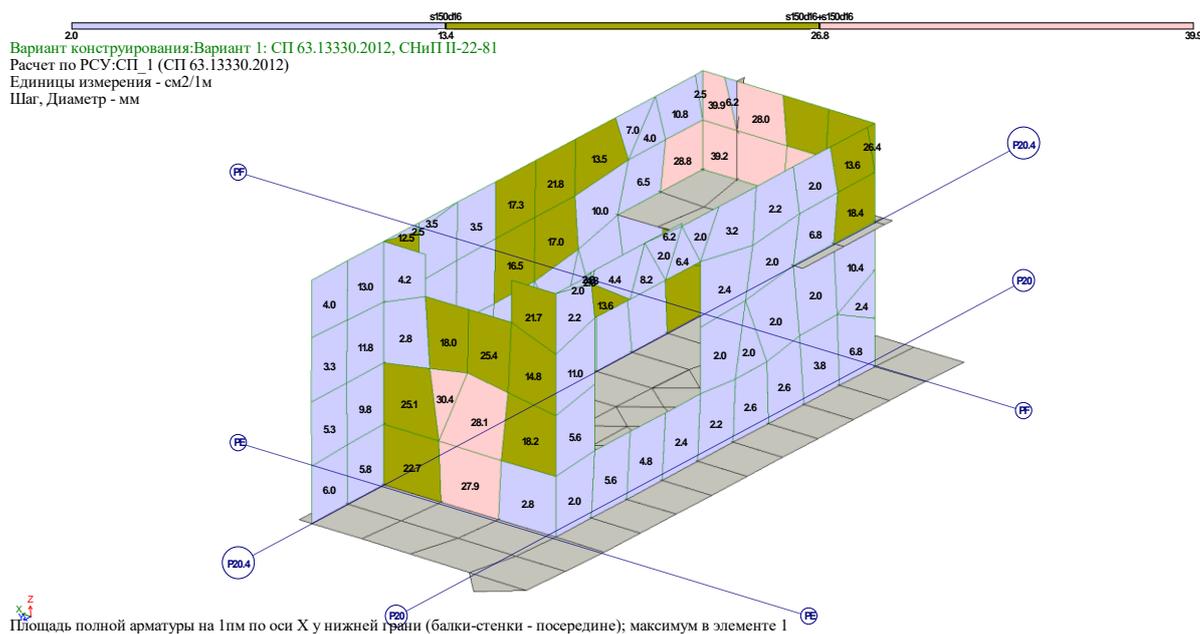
Расчет армирования стен с проемами. Площадь полной арматуры на 1м по оси X у нижней грани (балки-стенки - посередине)
